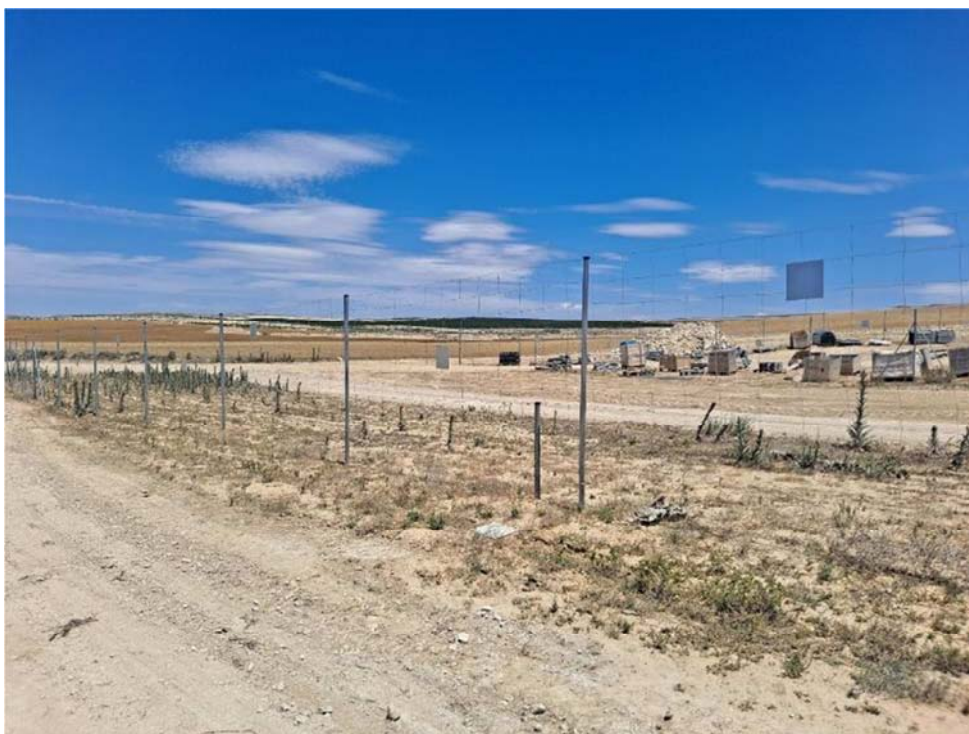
Tramo del vallado de “Épila 2A” donde se han colocado las placas que faltaban
